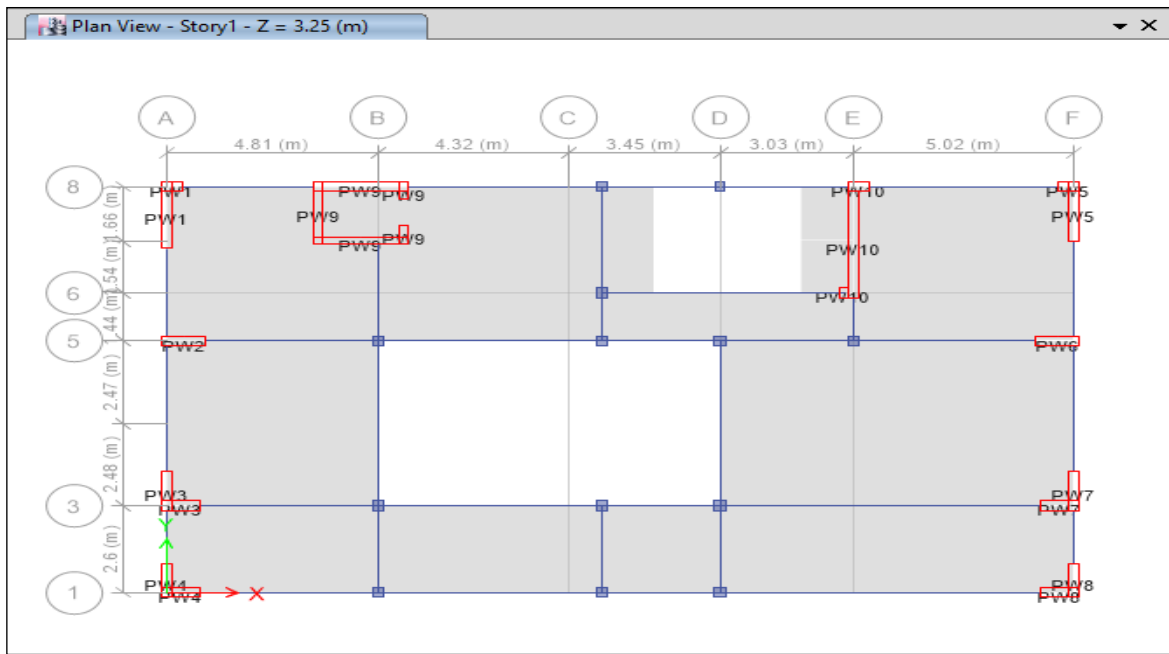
Vista en planta de los Muros de Corte del 1º al 6º de la Edificación “MARBELLA”.
